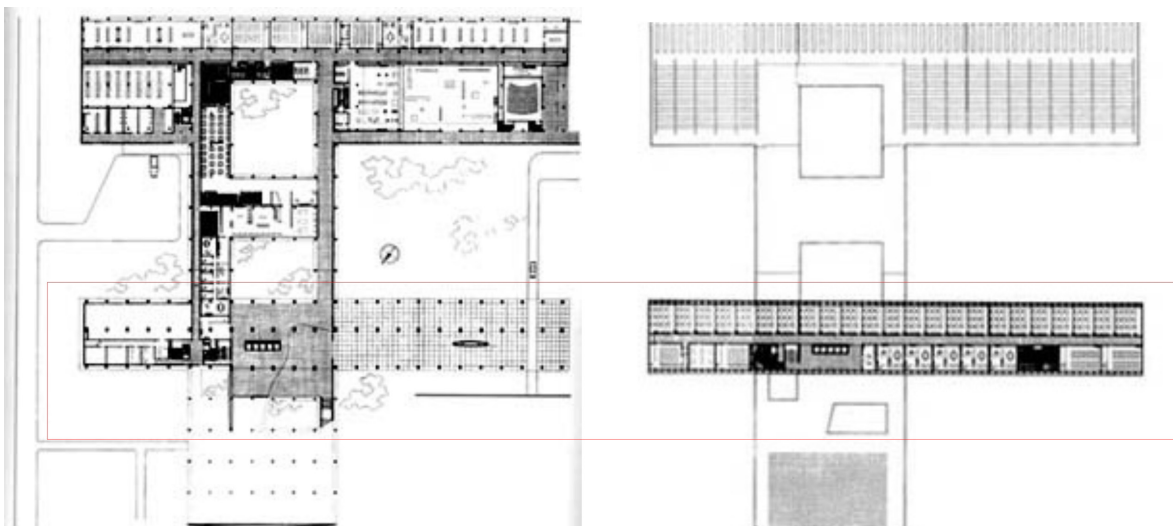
Faculdade Nacional de Arquitetura – plantas do térreo e do pavimento-tipo. Jorge Machado Moreira e equipe do ETU, 1957-60.
